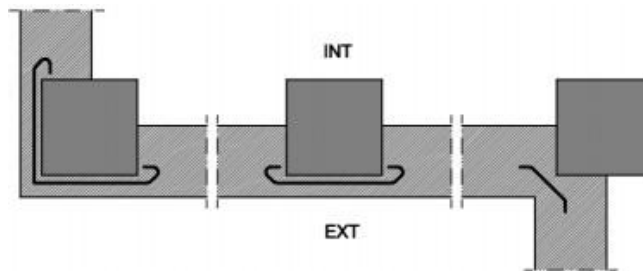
Ejemplo de encuentro de la fachada con los pilares
